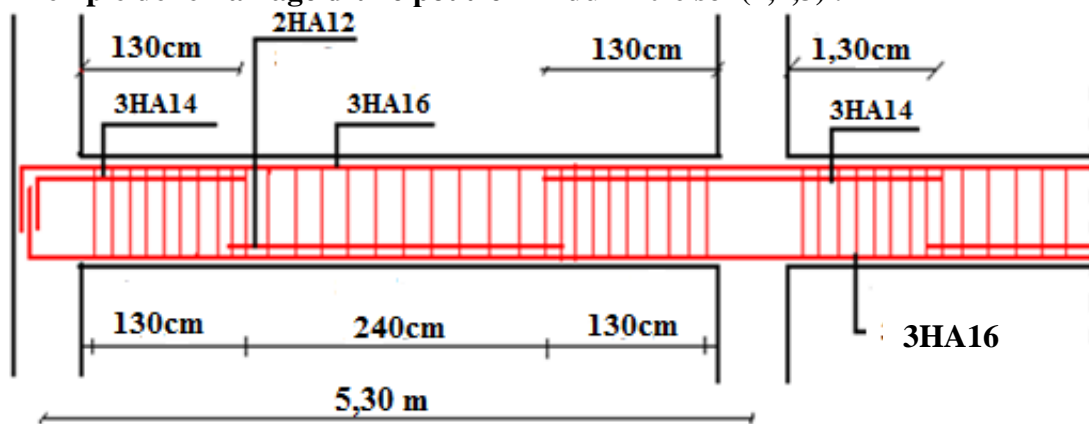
Exemple de dispositions constructives de la poutre principale.
